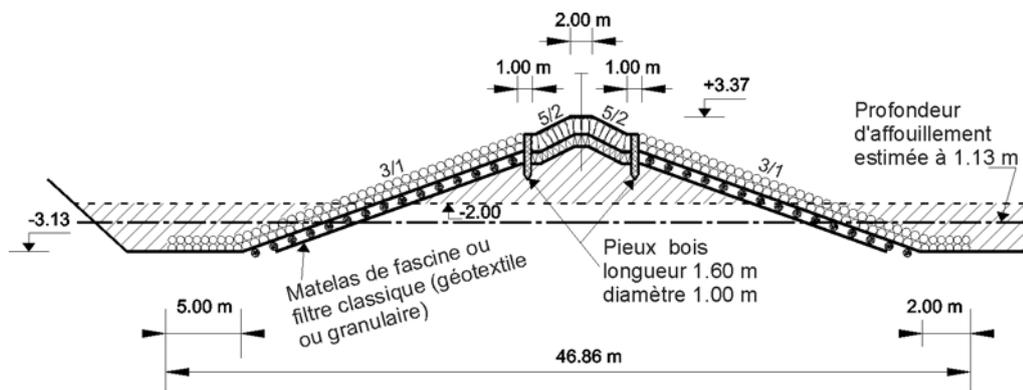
Extension d'un pied d'épi en prévision de l'affouillement
